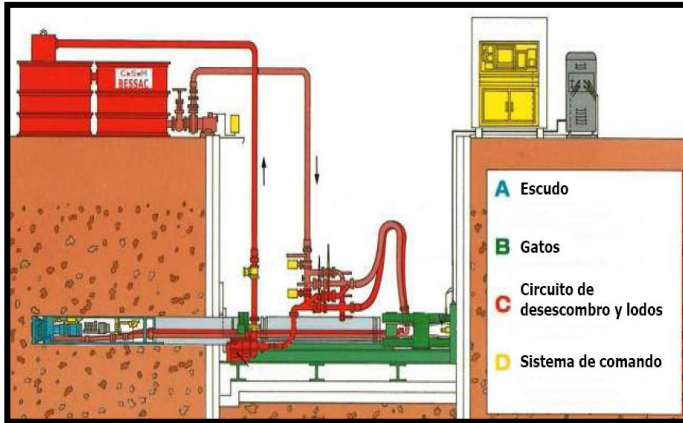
Esquema de Funcionamiento Pipe Jacking AVN. Bessac, 2011
